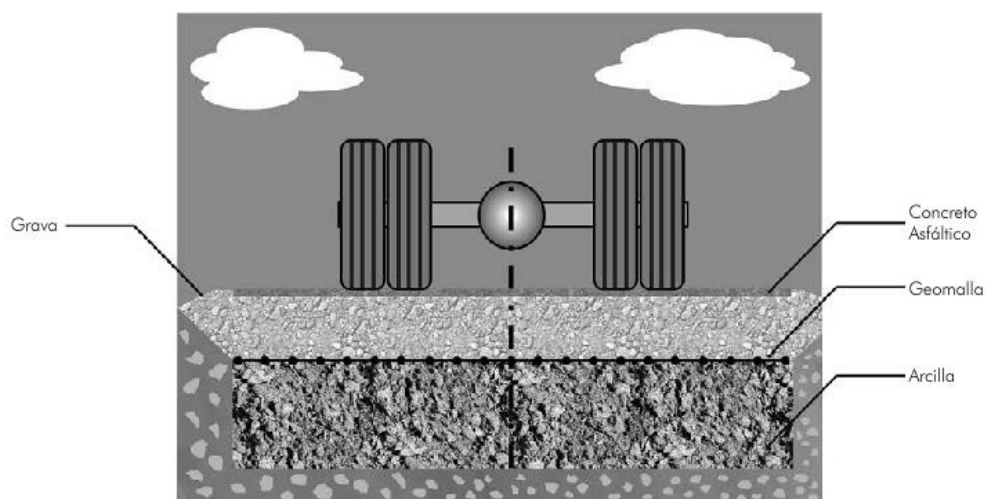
Vista en corte de la sección típica de la vía del ensayo
